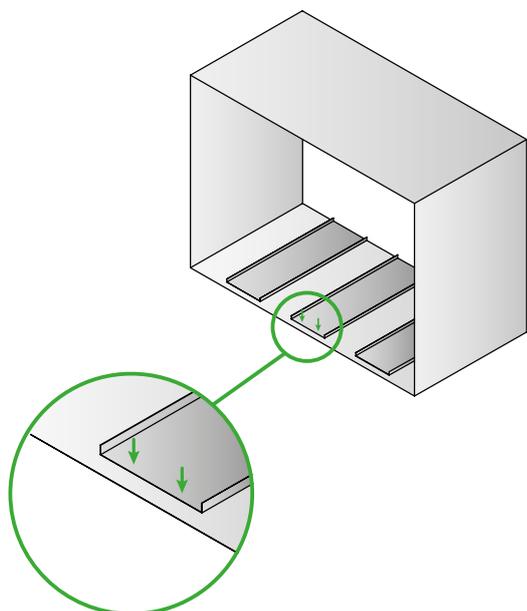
Bauen Sie die Montagegeschienen mit Schrauben oder Blindnieten im Kanal ein.
